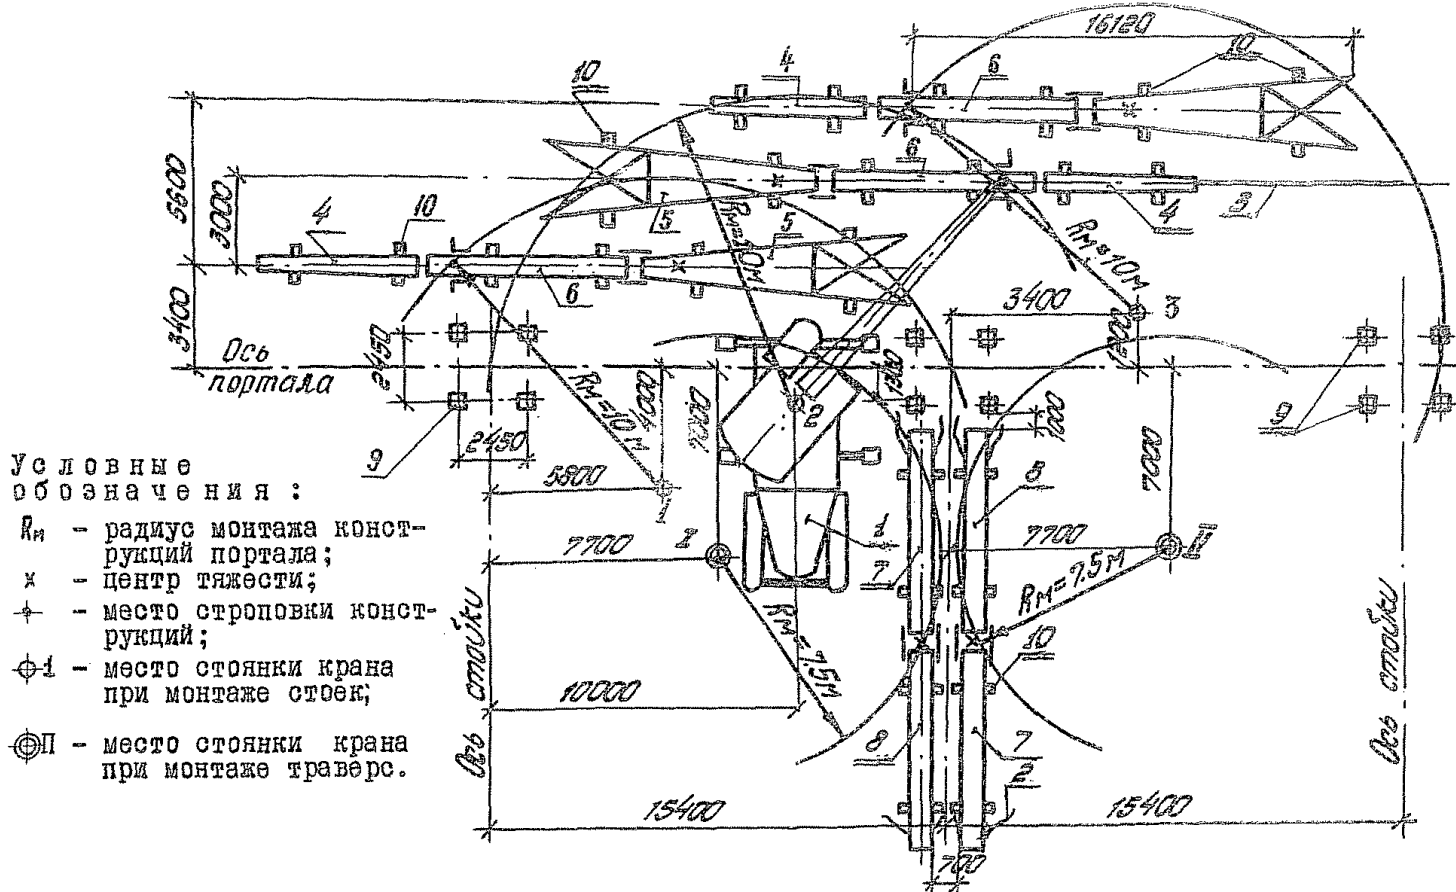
Схема сборки и монтажа металлоконструкций портала:
